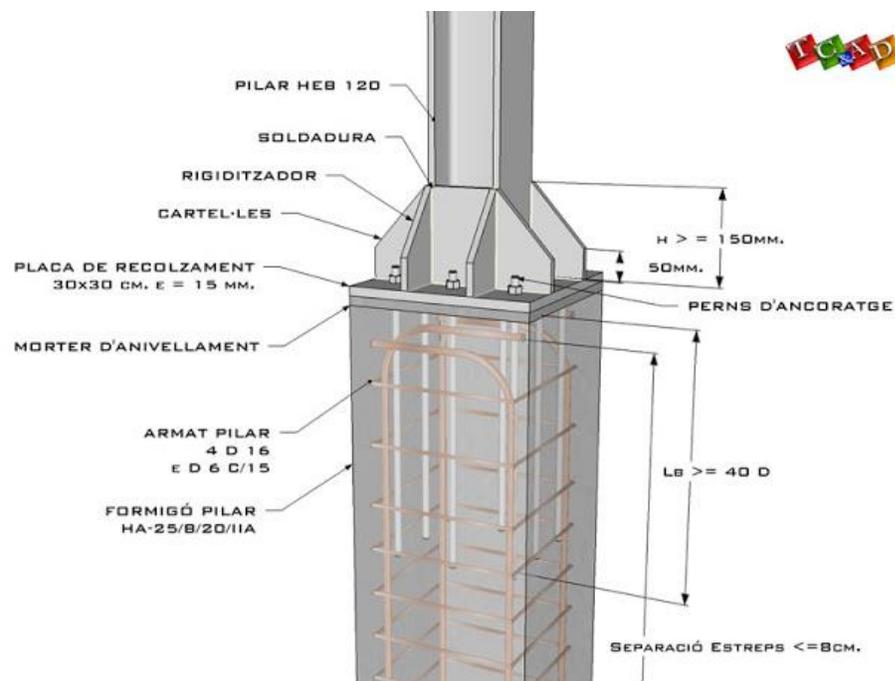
Detalle Estructural Encuentro de Pilar de Hormigón Armado con Pilar Metálico
